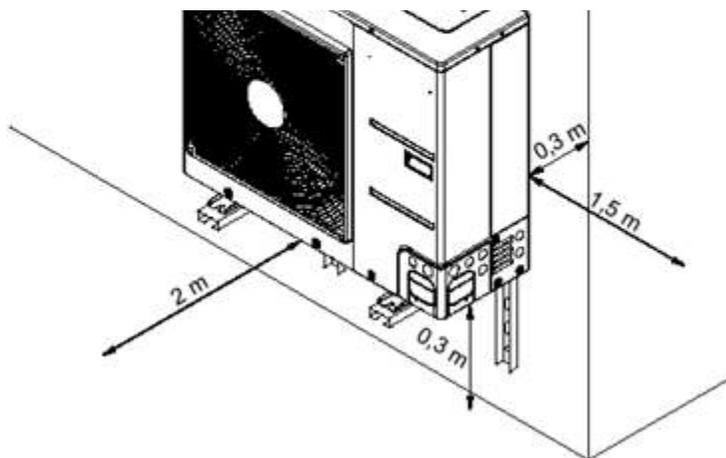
Installazione del posto esterno LAW 9IMR tramite staffa a parete
